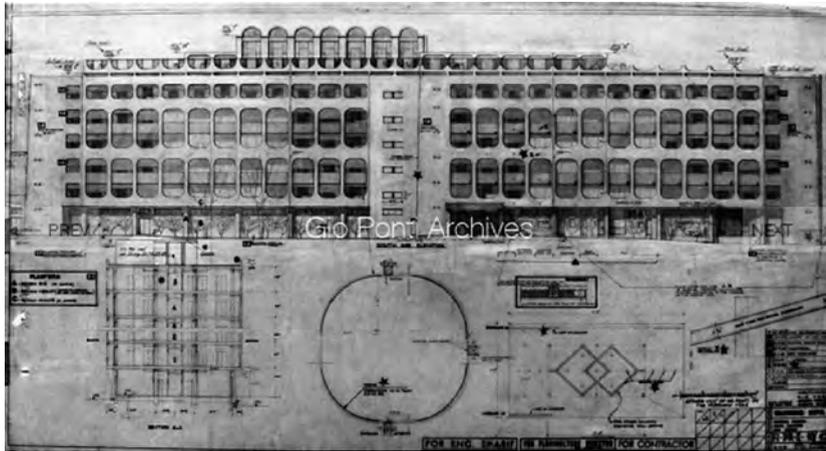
Gio Ponti, dibujo fachada hotel Pakistan House, 1962
